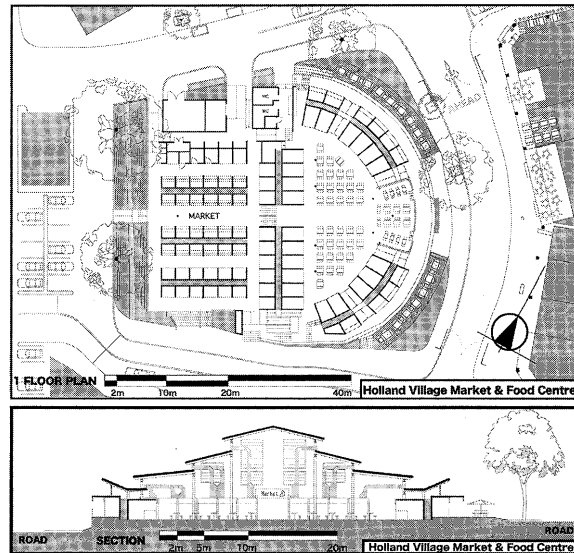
(中央列):HUP後の(12)Holland Village Market & Food Centreの平面・立面図
